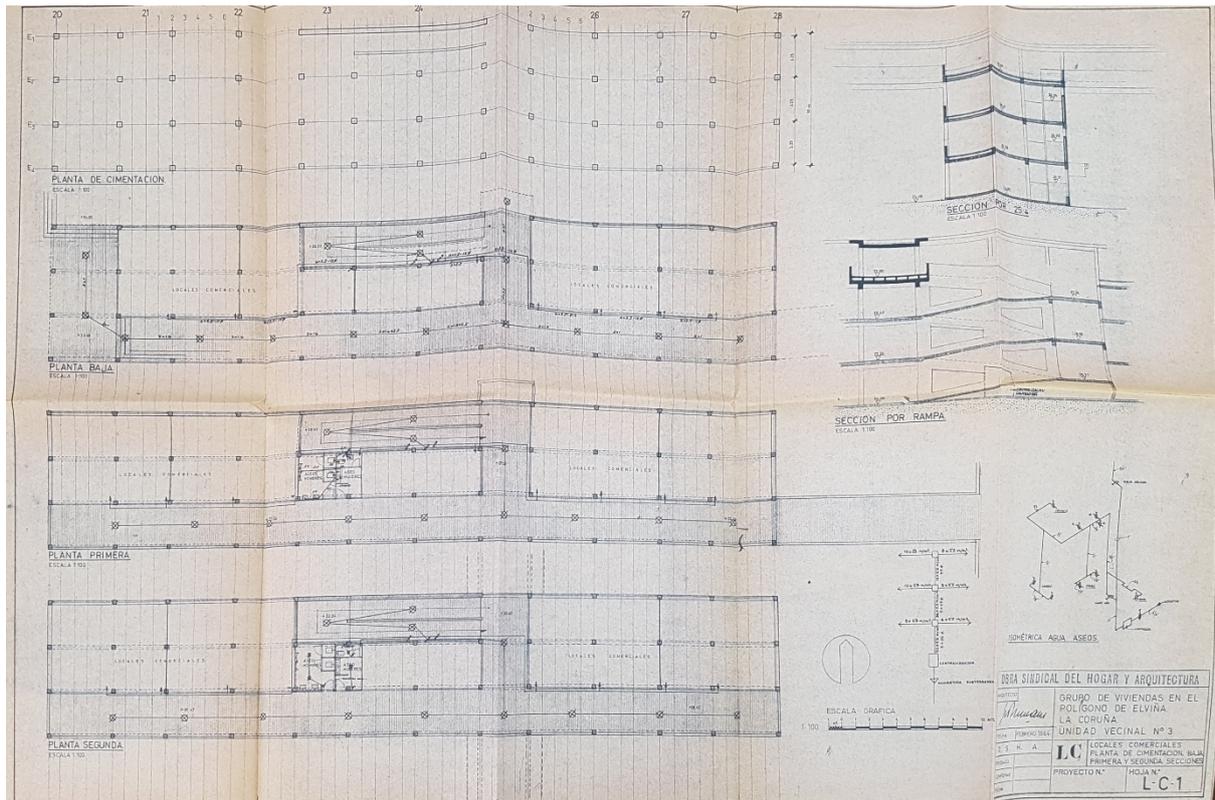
Plantas locales comerciales en rampa. 1964. Fuente Archivo Municipal da Coruña
